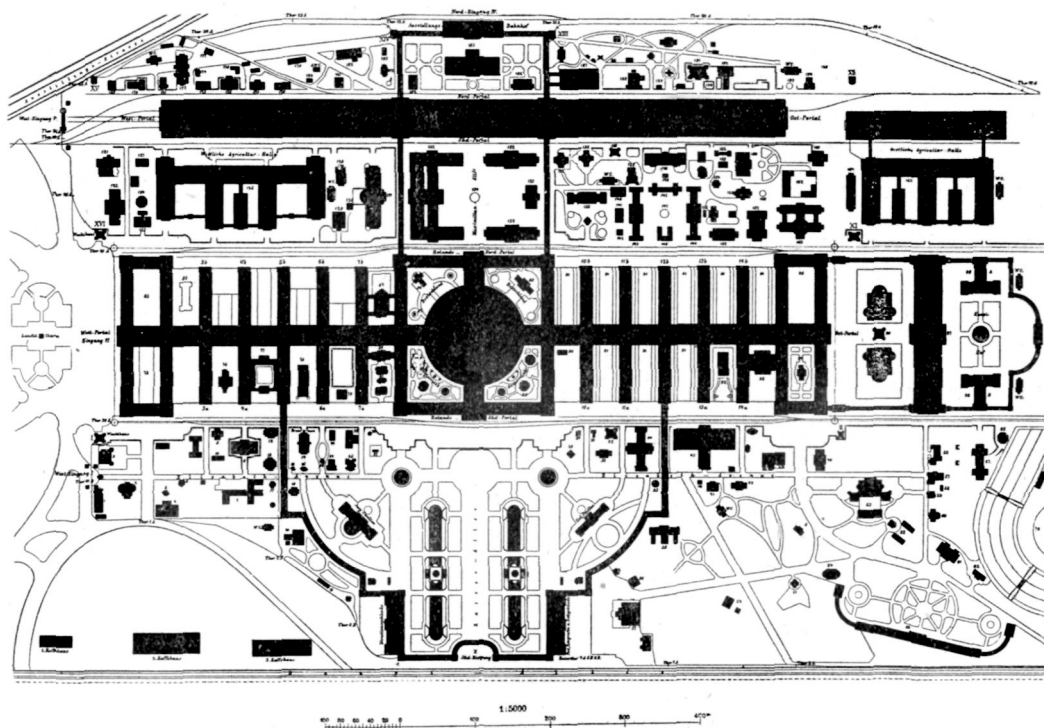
Ausstellungsanlage Wien 1873. Lageplan
